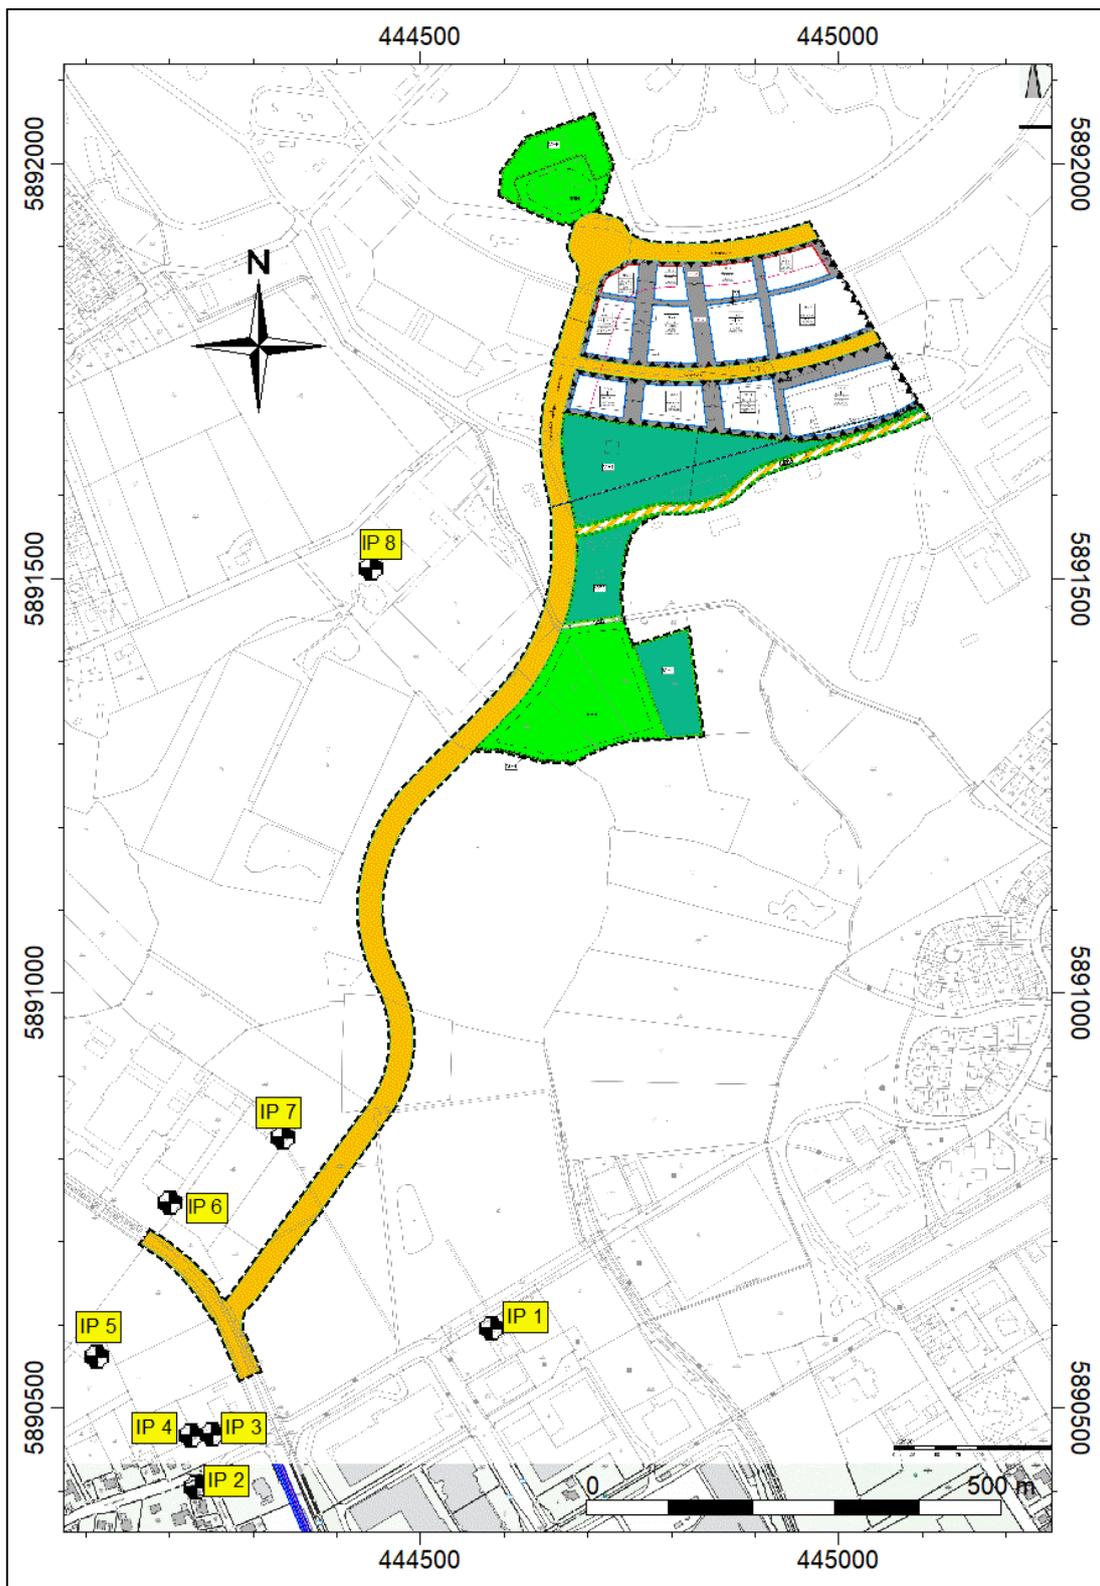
Lageplan der maßgeblichen Immissionsorte (hinterlegter Plan: Quelle [8]).
